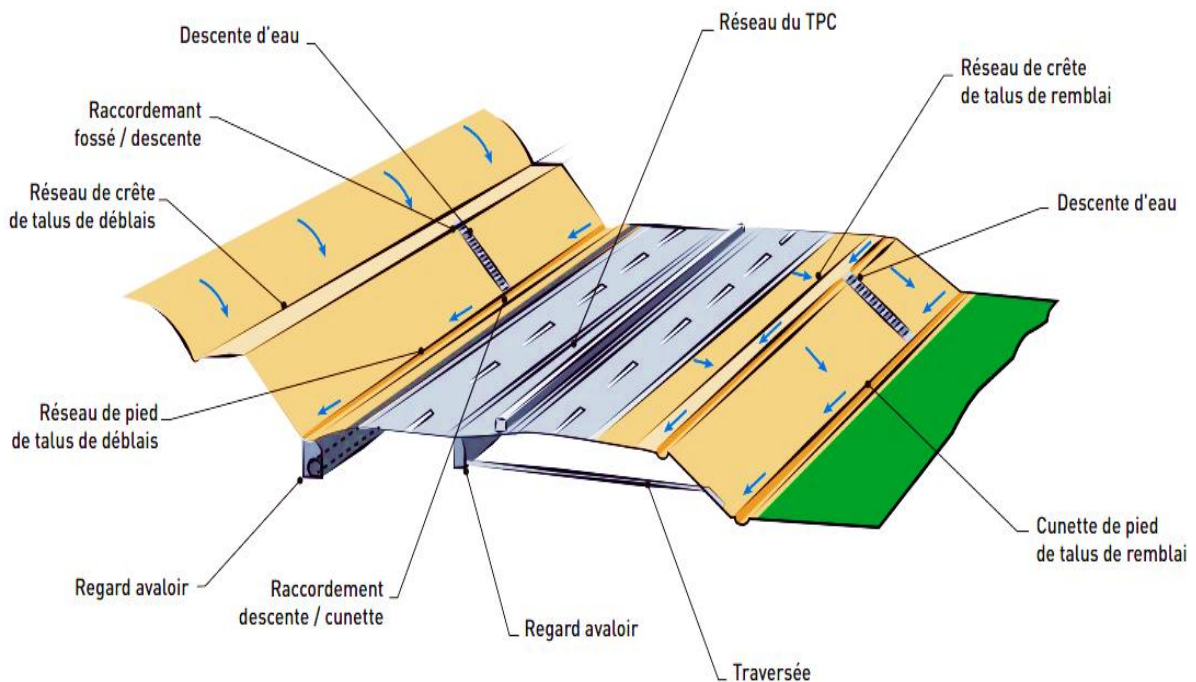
Réseaux d'Assainissement d'une Chaussée Routière
